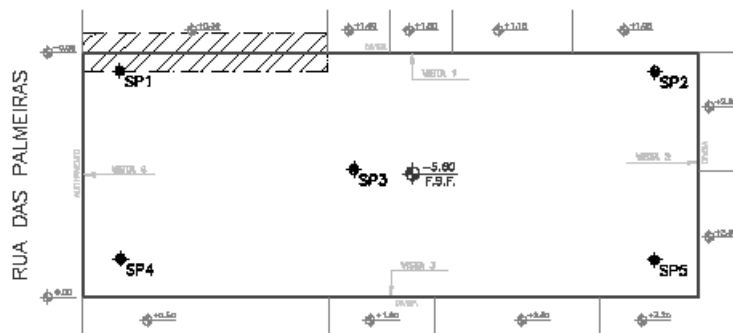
Vista en planta de la obra, con destaque para el área de estudio.
